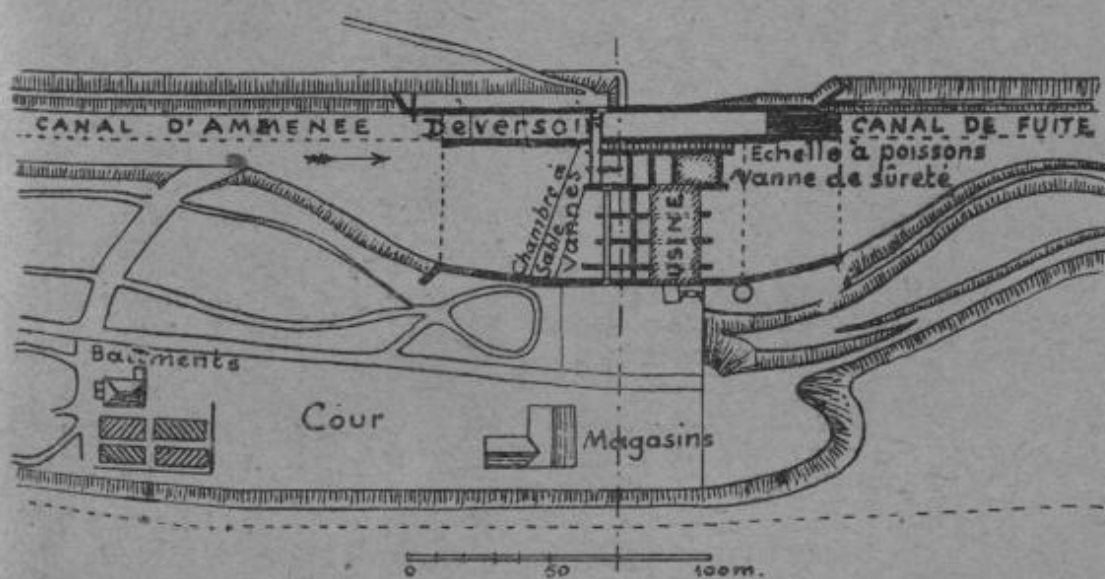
Usine de Uppernborn. Plan des ouvrages hydrauliques à l'usine centrale.
